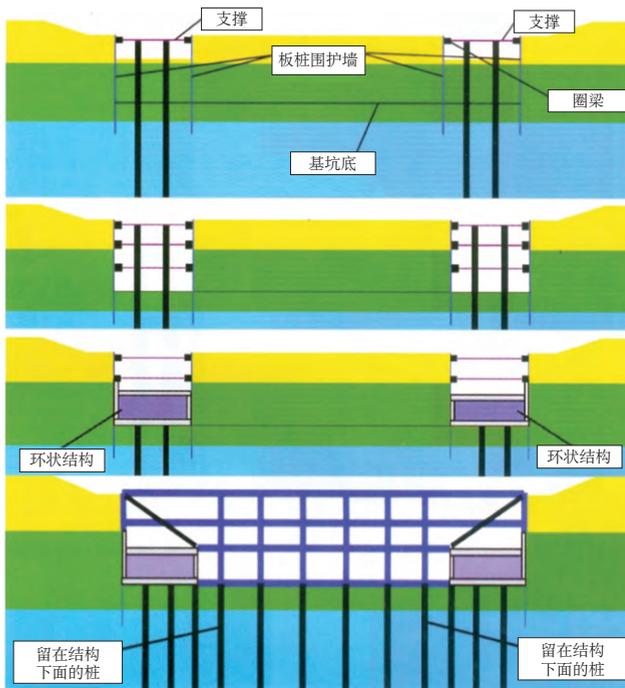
在建立环状钢筋混凝土刚性结构的条件下开挖基坑的步骤
